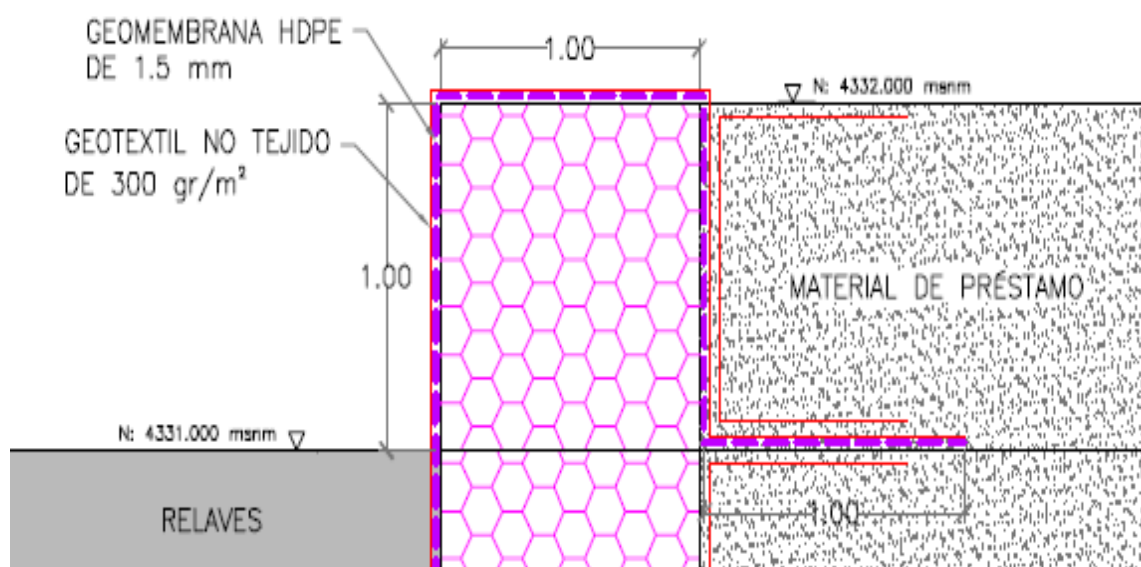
Detalle de anclaje de Geomembrana en muro de recrecimiento
